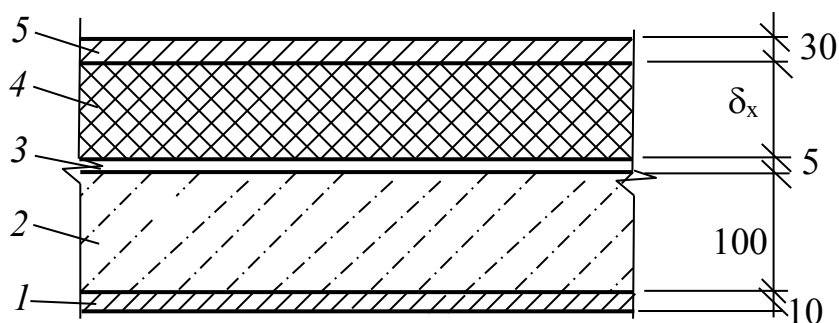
Вариант 2 конструкции чердачного перекрытия:
